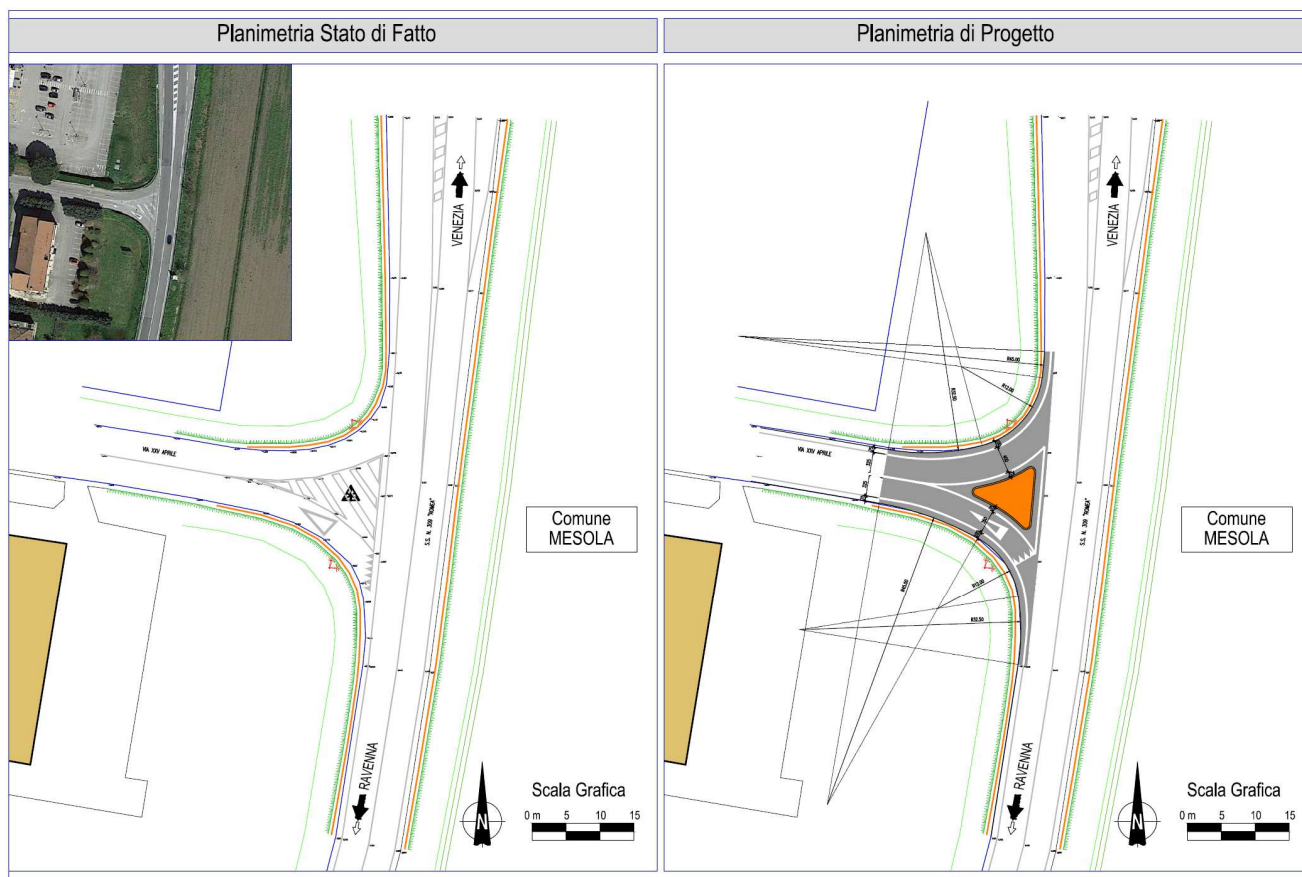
Intervento n°25 – Planimetria Stato di fatto – Progetto
